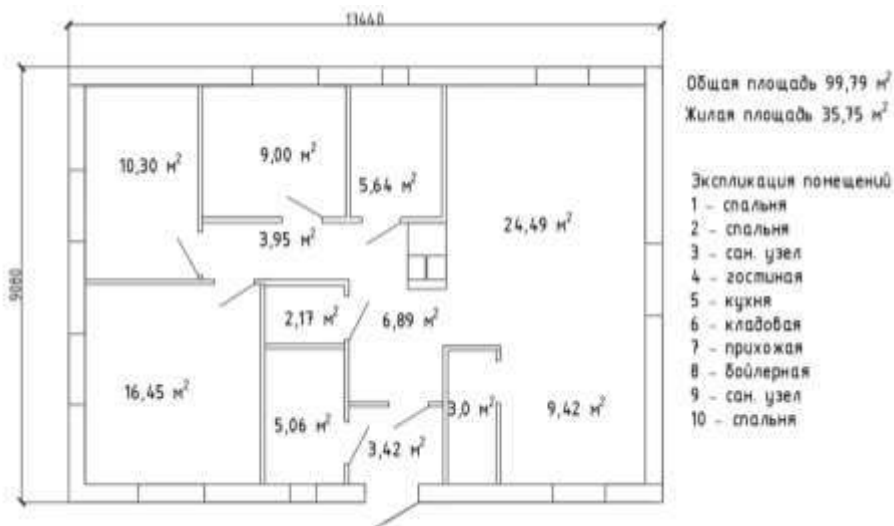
План одноэтажного дома со стенами из силикатного кирпича
